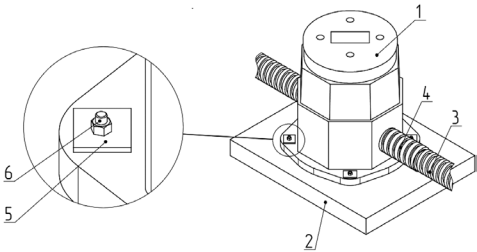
Схема крепления кабельного колодца ККП-2-ССД на плите
